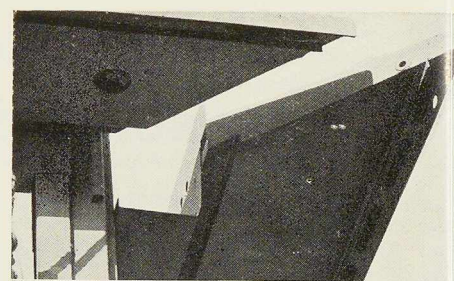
Assemblage d'une poutre transversale et d'une colonne intérieure.
